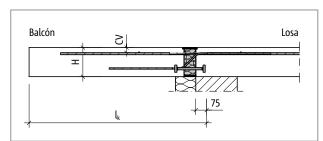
Schöck Isokorb® T tipo K-M12: Sistema estático
